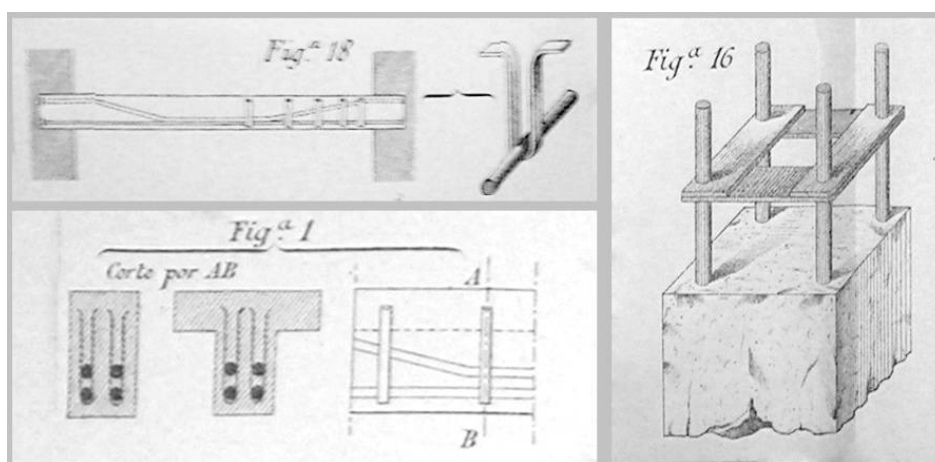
Viga y pilar propuestos por Hennebique (Marvó, 1902).
